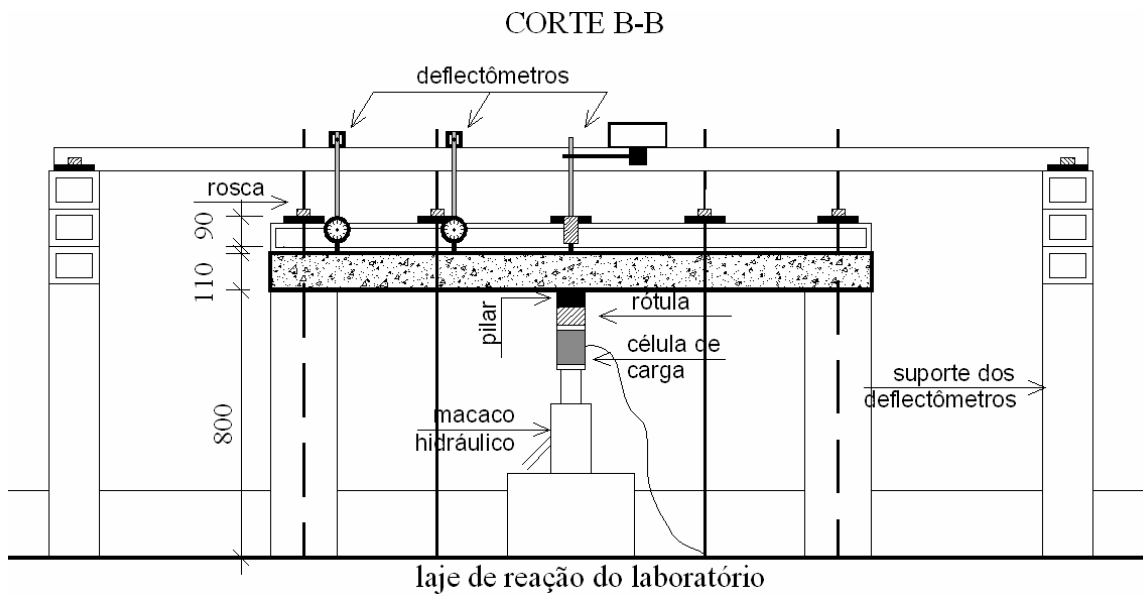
Sistema de ensaio das lajes – Corte BB
